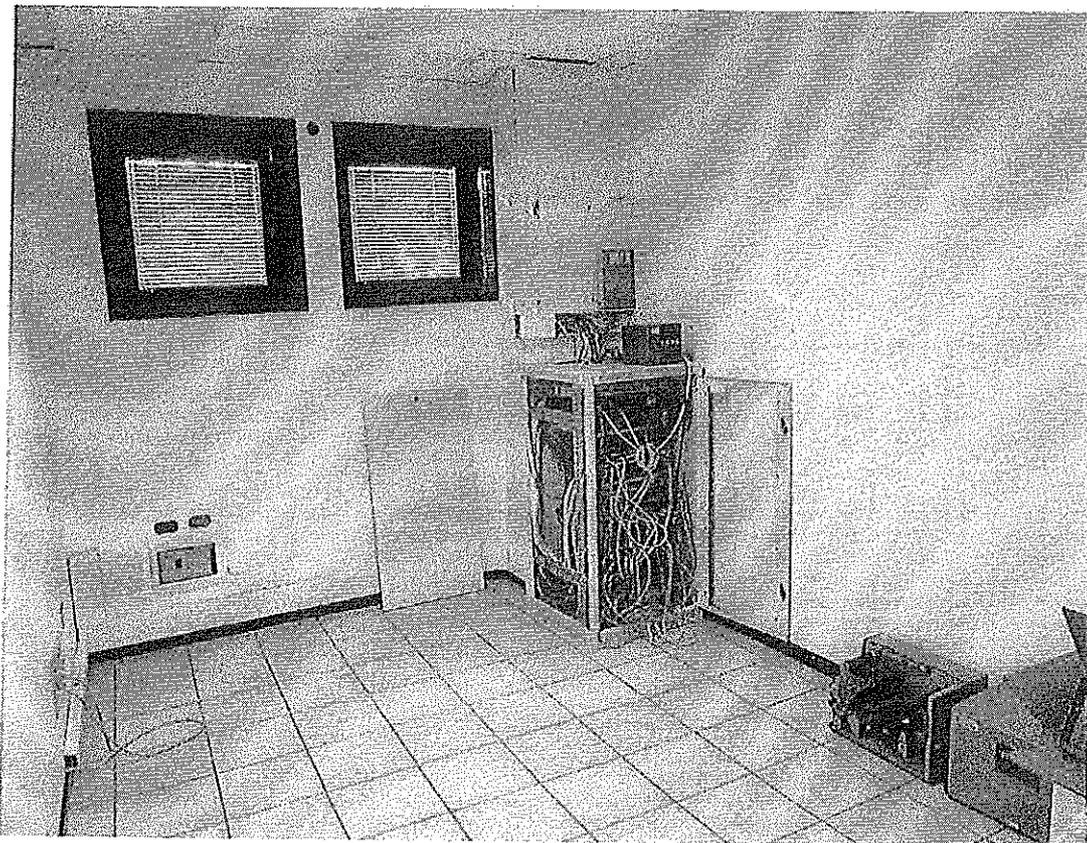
Annesso adibito ad uffici – vista interna parziale.
